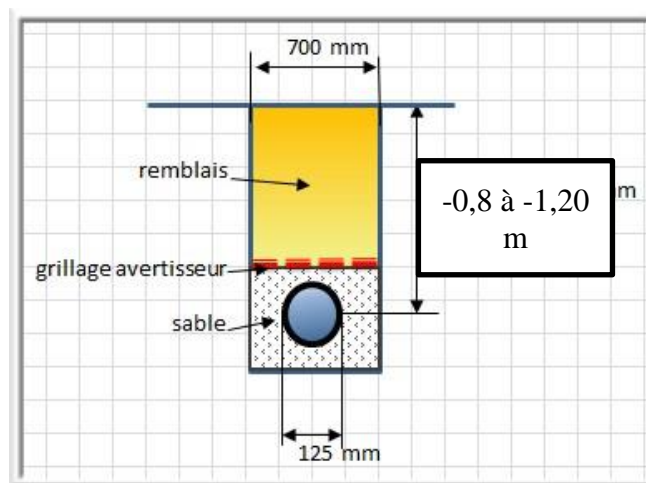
Coupe transversale de l'enfouissement d'une conduite
